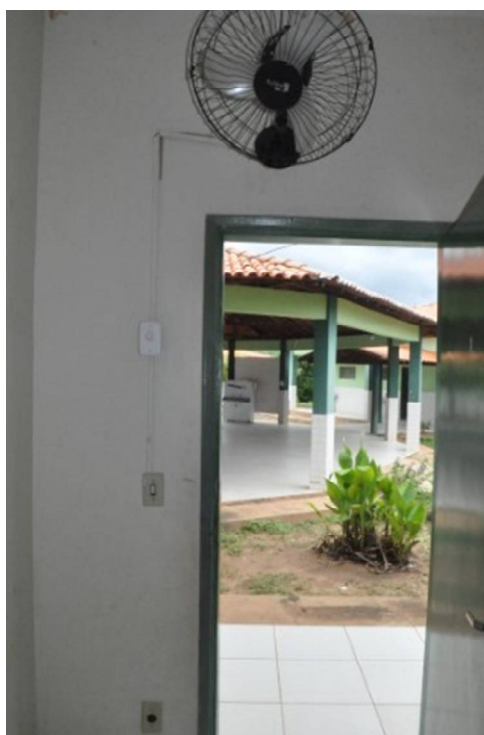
Vista geral: Parede anterior almoxarifado.
